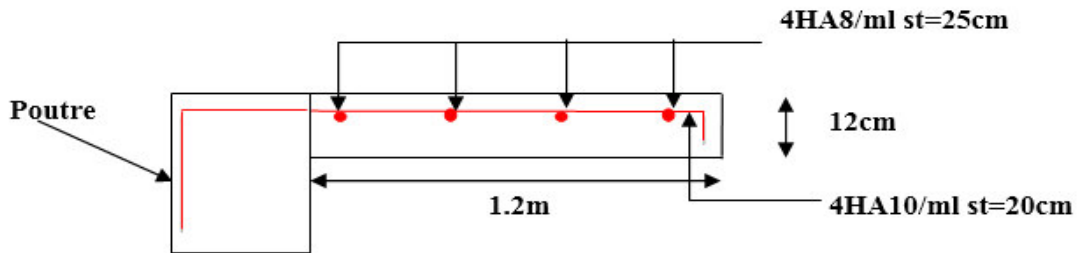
Schéma de ferrailage d'une dalle sur un seul appui.
